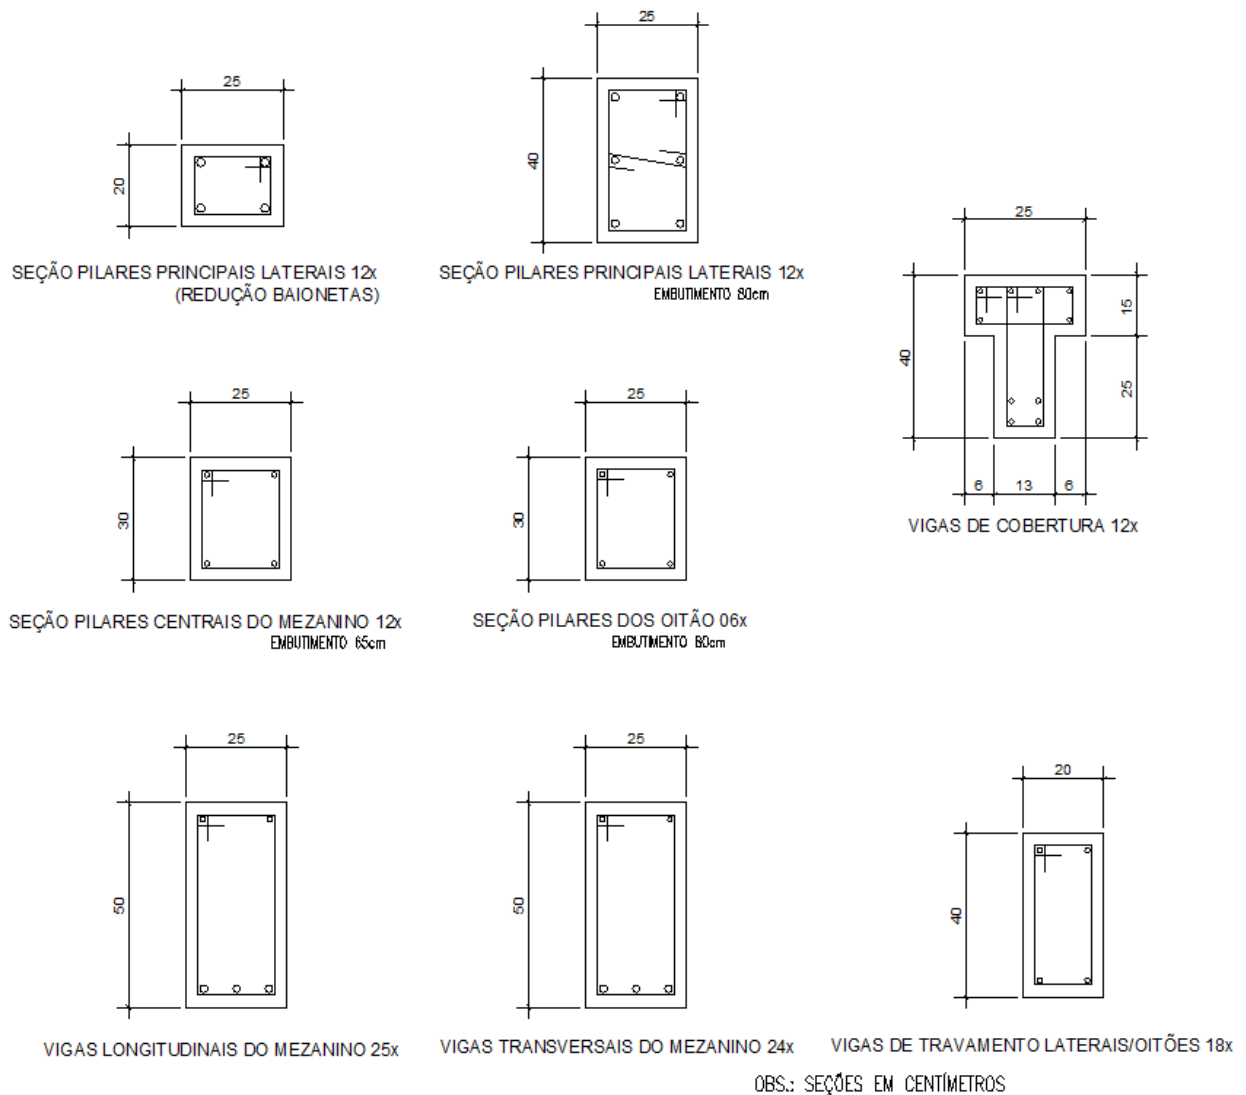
Seções transversais dos elementos utilizados pela edificação para estrutura em concreto pré-moldado.
